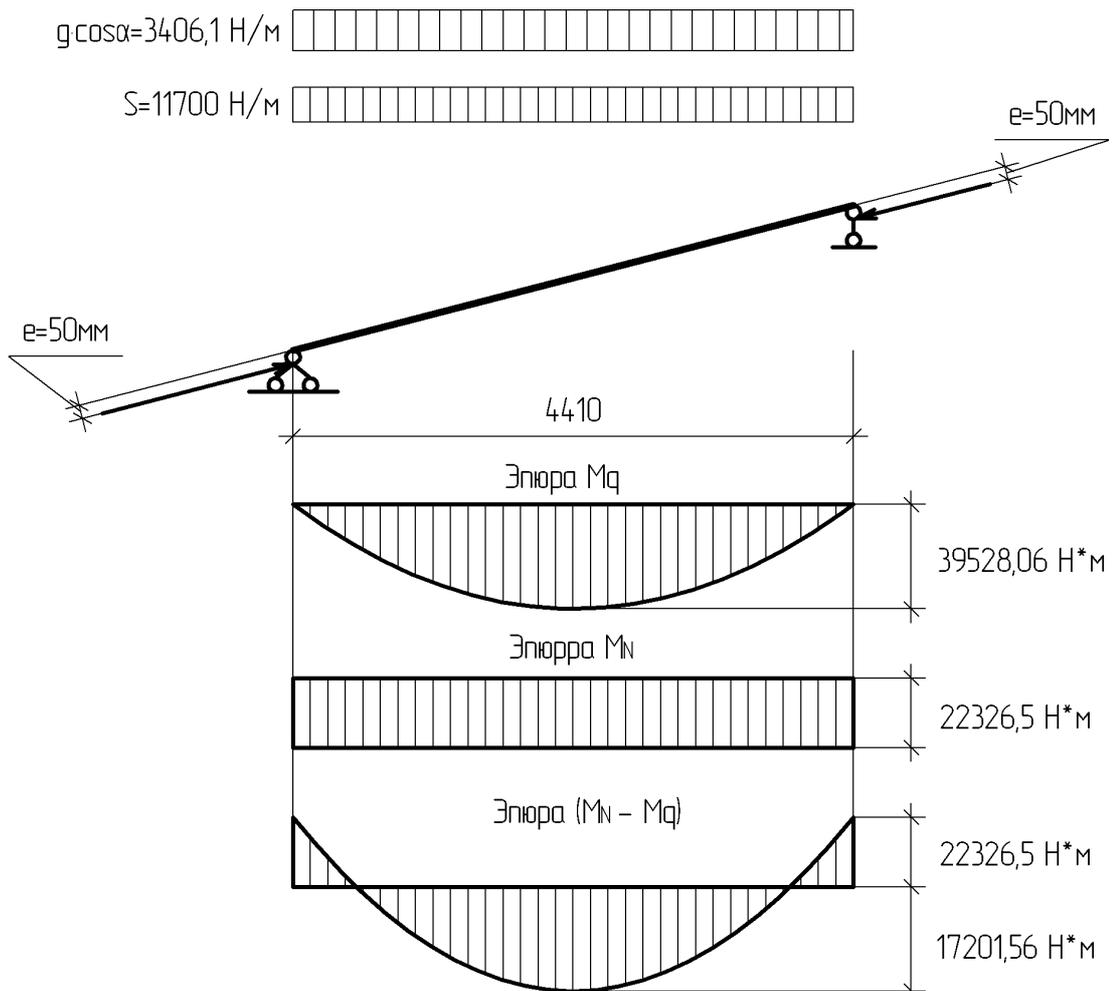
Расчетная схема верхнего пояса фермы
